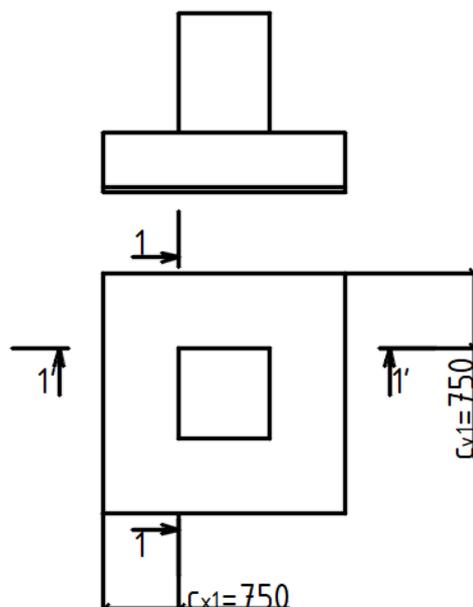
Схема к расчету арматуры плитной части фундамента
